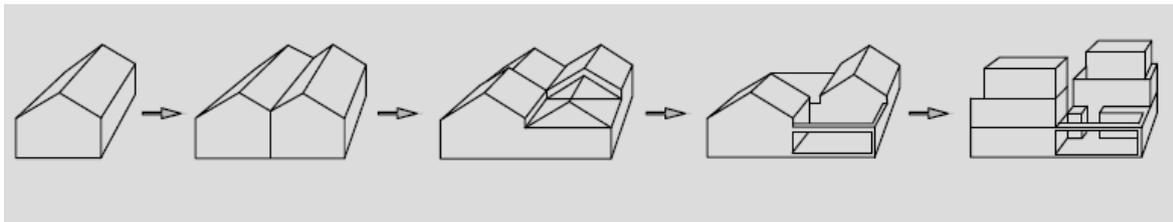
Diagrama de partido arquitectónico. Fuente: <https://www.archdaily.com/42539/rural-mat-njiric-arhitekti>.
